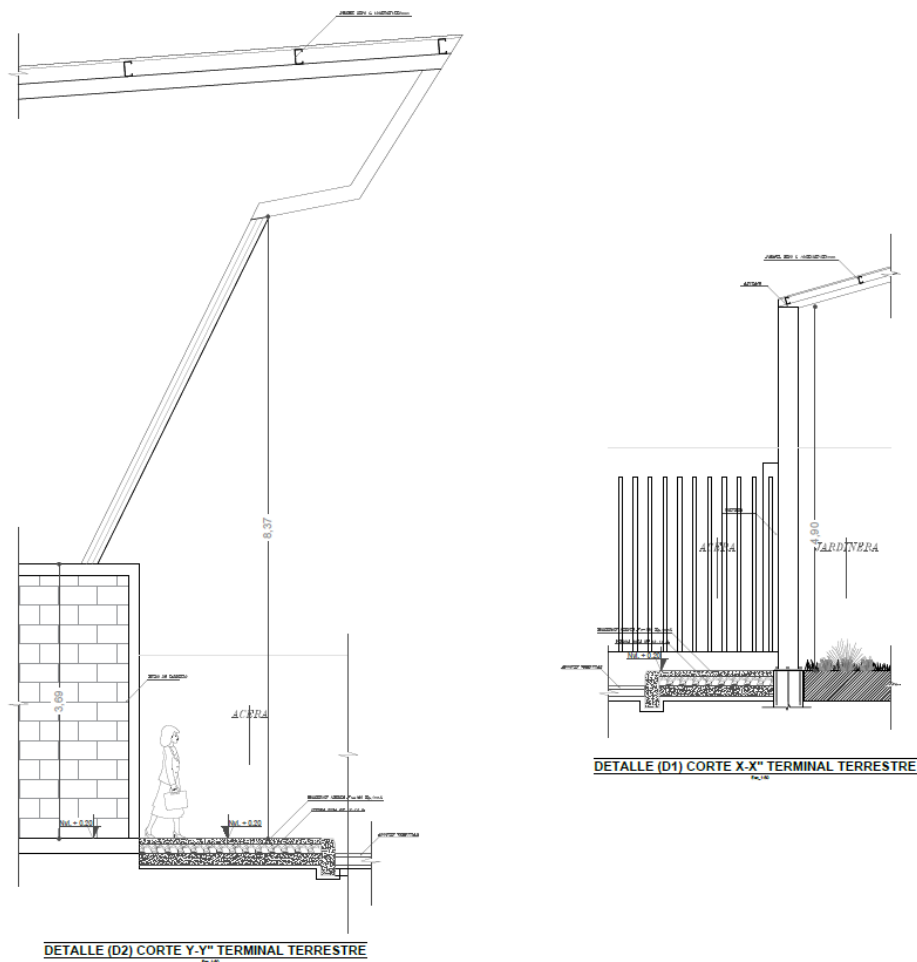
Detalles D1 y D2 de Cortes Longitudinal y Transversal
